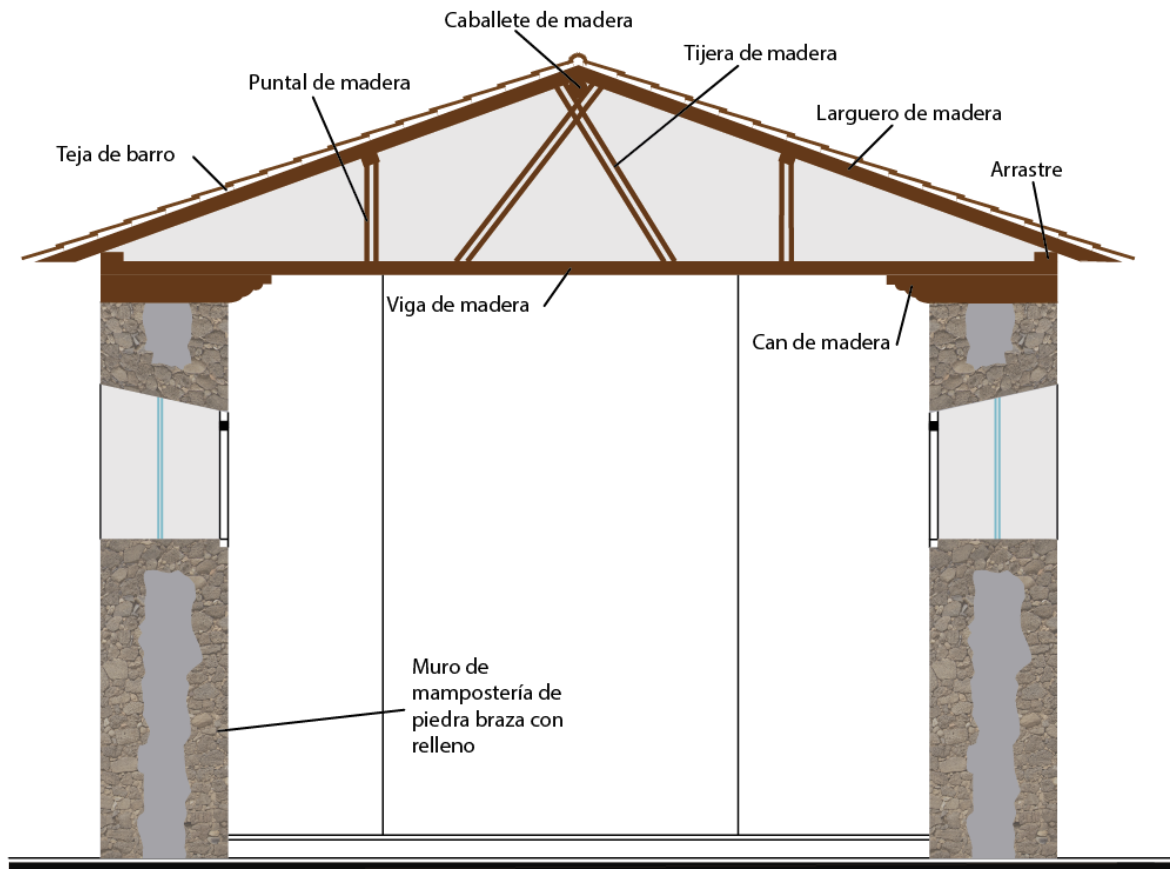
Corte de la nave para ver sistema constructivo. Elaboración propia.
